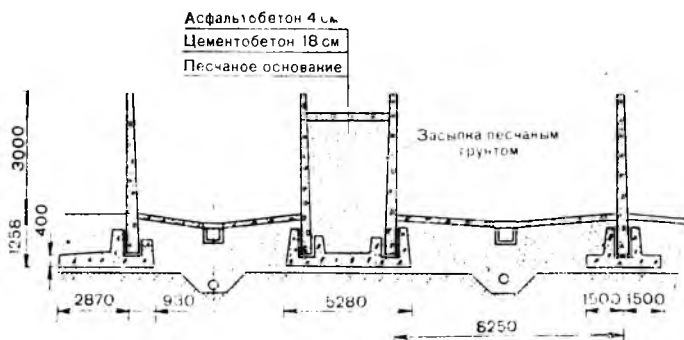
Разрез восьмисекционного наземного хранилища сенажа с верхней боковой загрузкой
